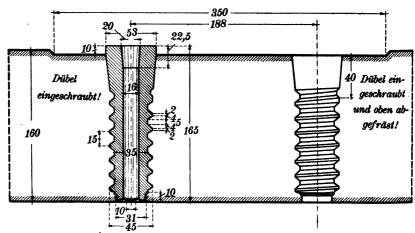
Dübel für neue Schwellen. M. 1:4.
